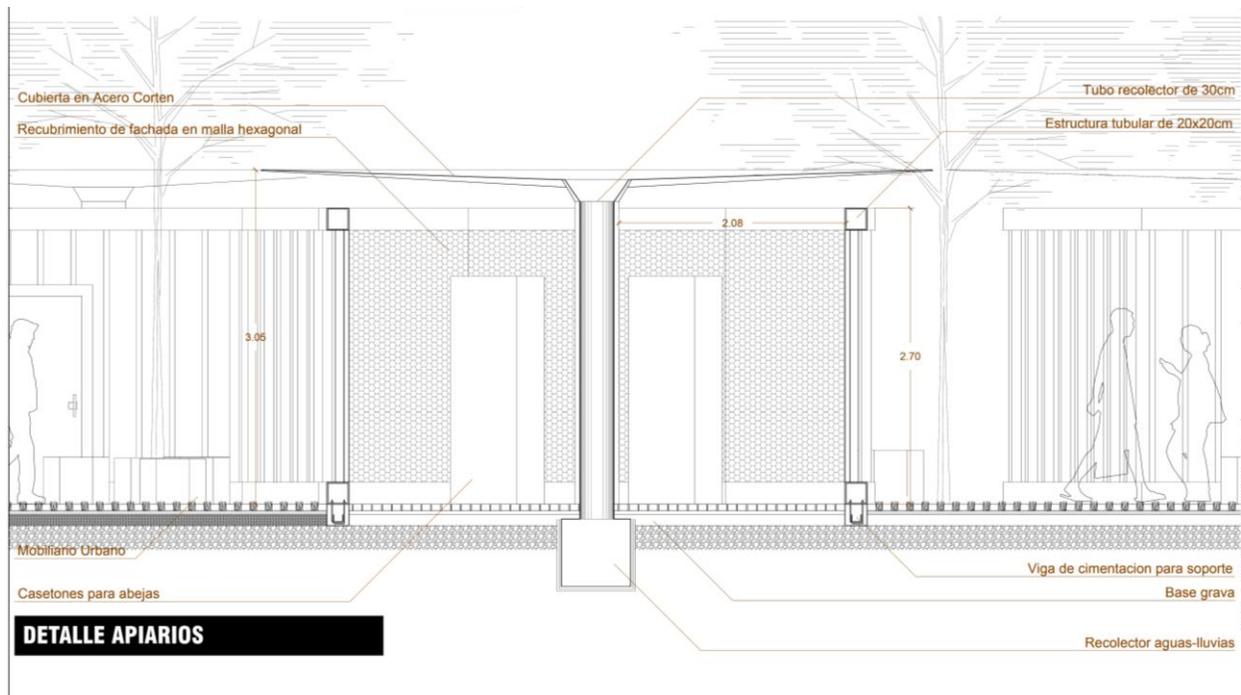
Vista – Detalles Constructivos. Fuente Propia.
